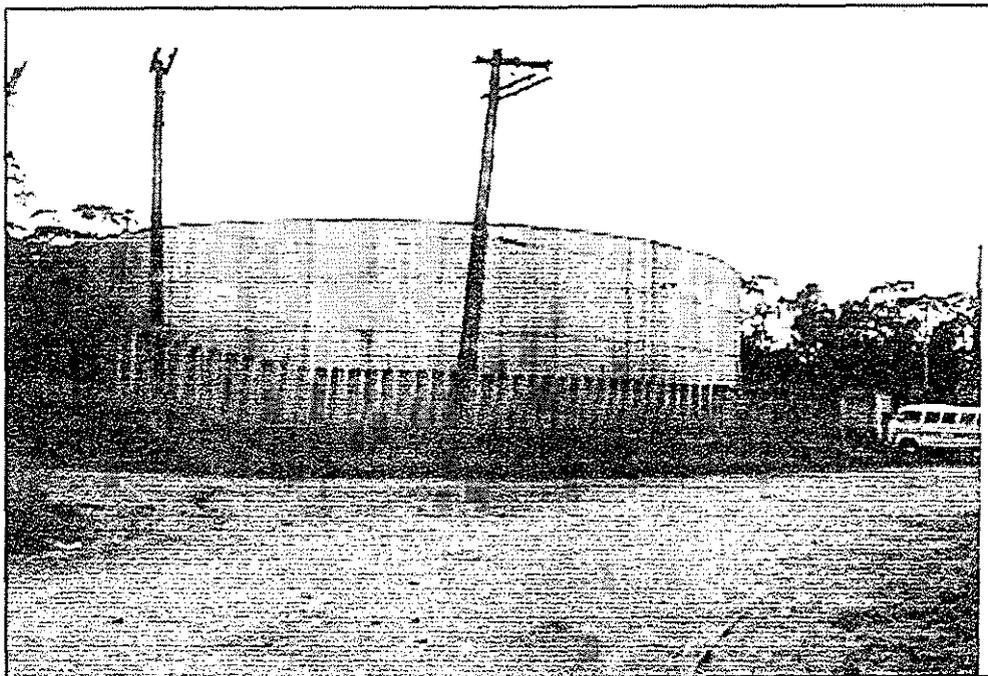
Vista geral do Stand-pipe – (SABESP – 2004)
